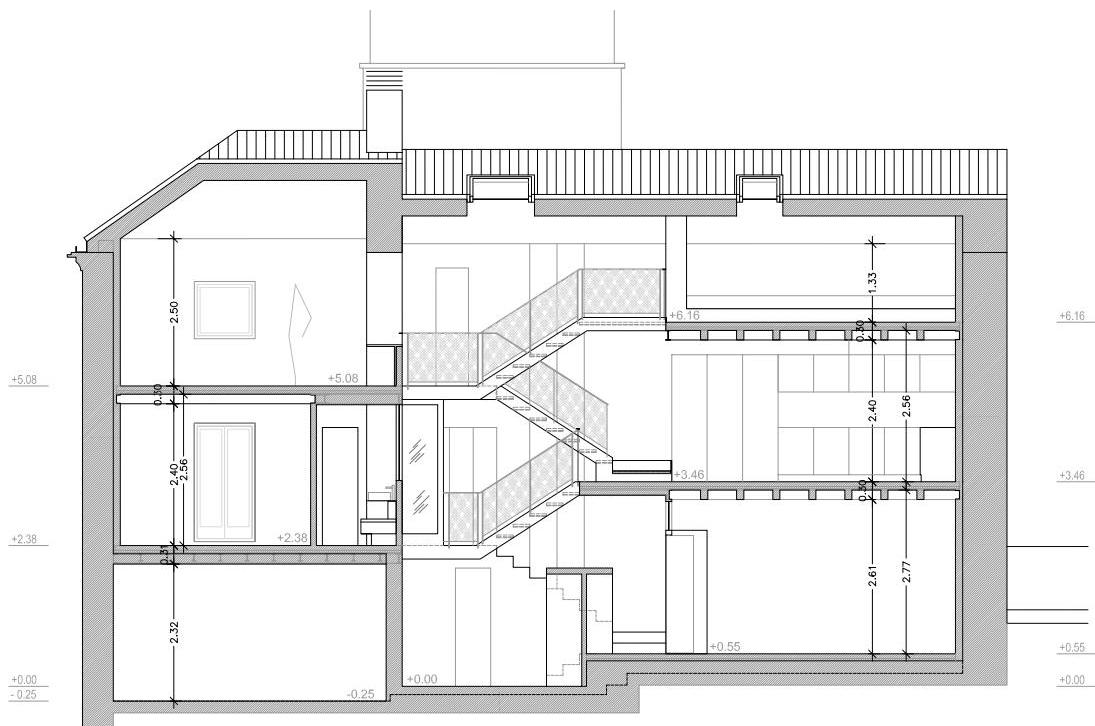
Sección longitudinal constructiva [Tourillon Arquitectura]
